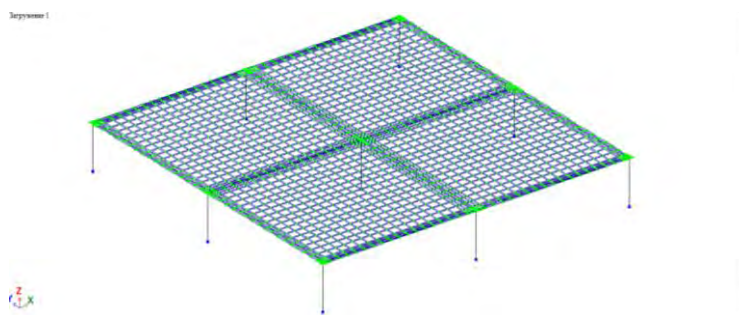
Схема перекрытия с колоннами.
